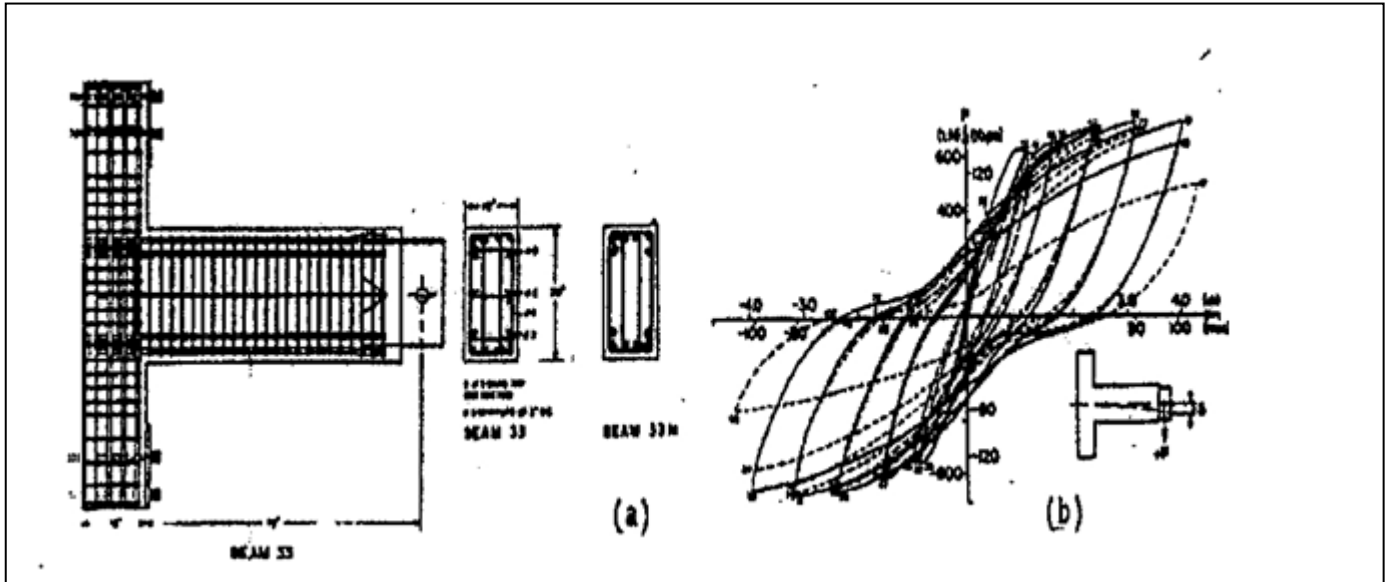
(a) poutre ferrailée normalement, (b) Boucles d'hystérésis
